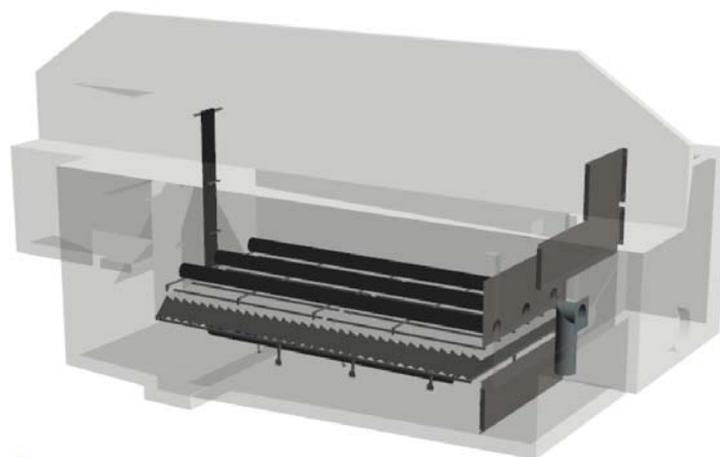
3D-Darstellung der Sanierung einer vorhandenen Betonanlage.
